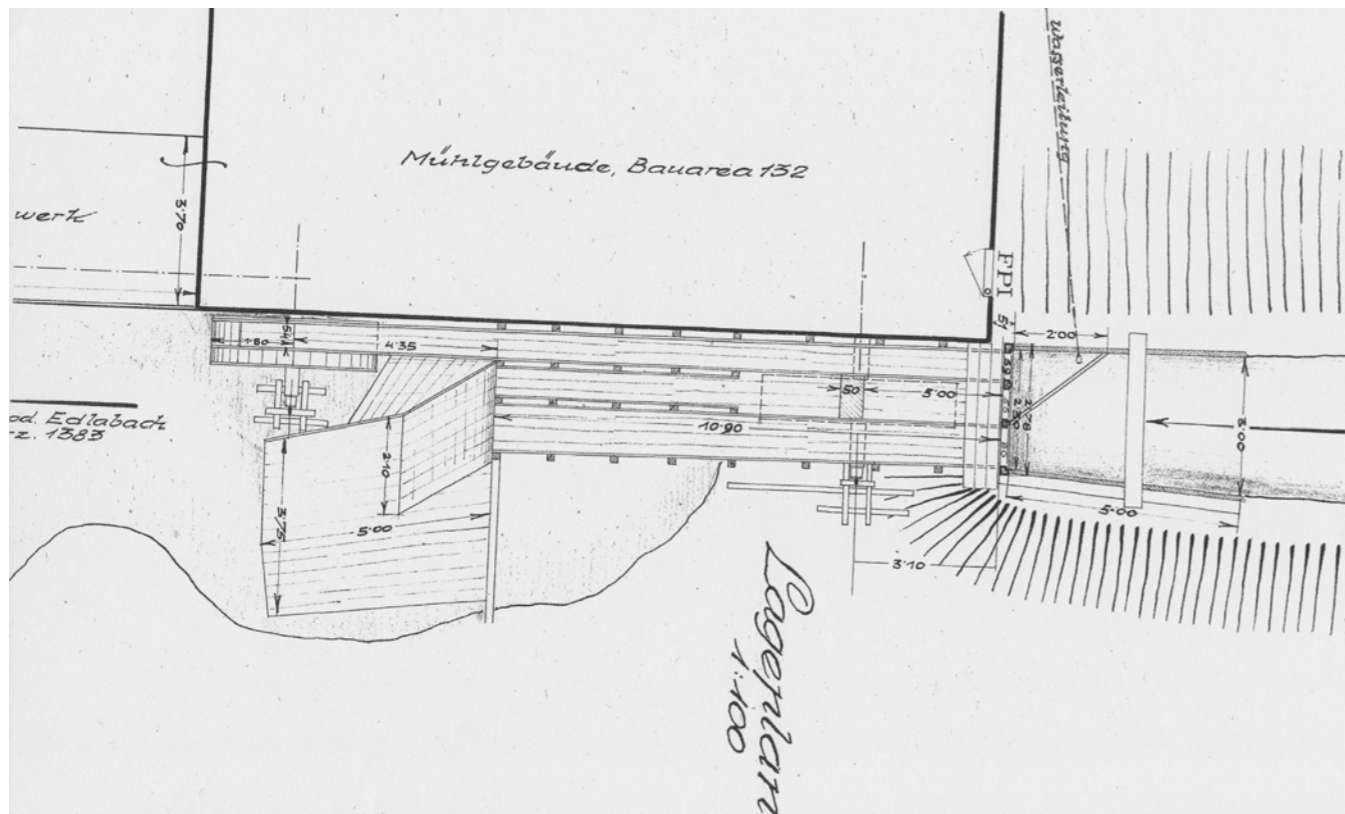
Lageplan der Wasserräder aus dem Wasserbuch
